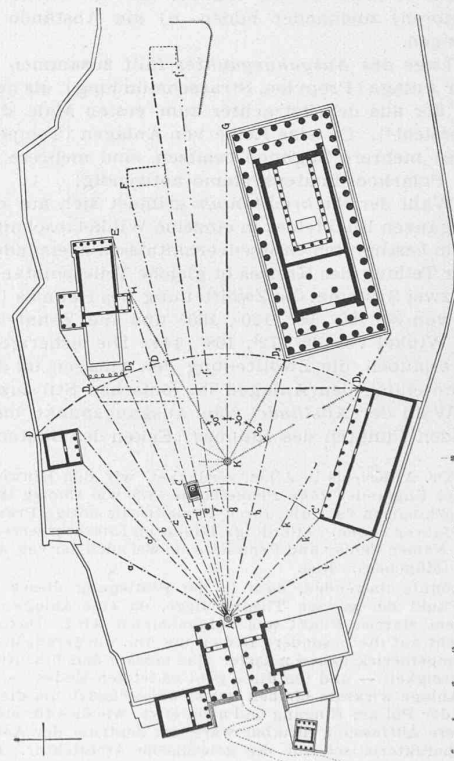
Grundriss der Akropolis, 1:2000
